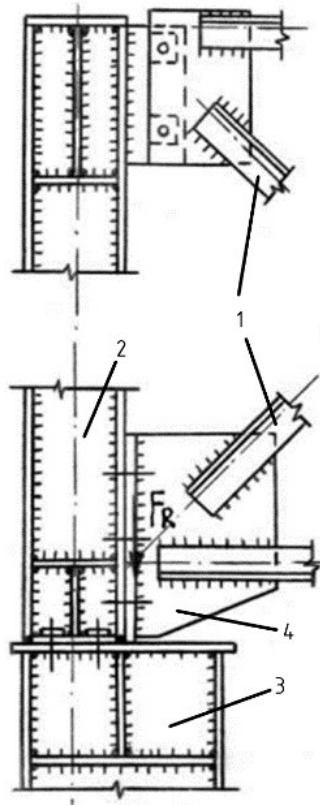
Узел опирания фермы на колонну сверху над колонной стойкой:
